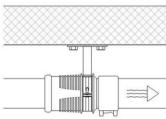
Collier point fixe isolé contre le bruit sur le manchon long Geberit Silent-db20
